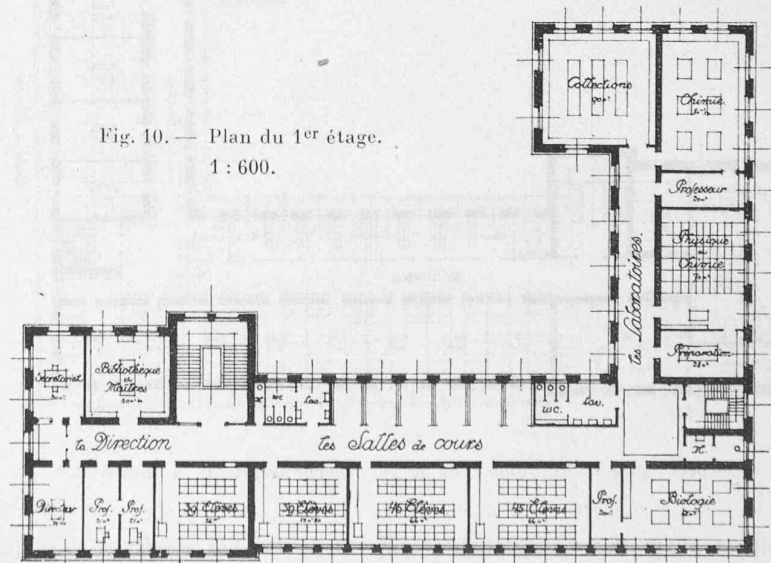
Plan du 1^{er} étage. — 1 : 600.
